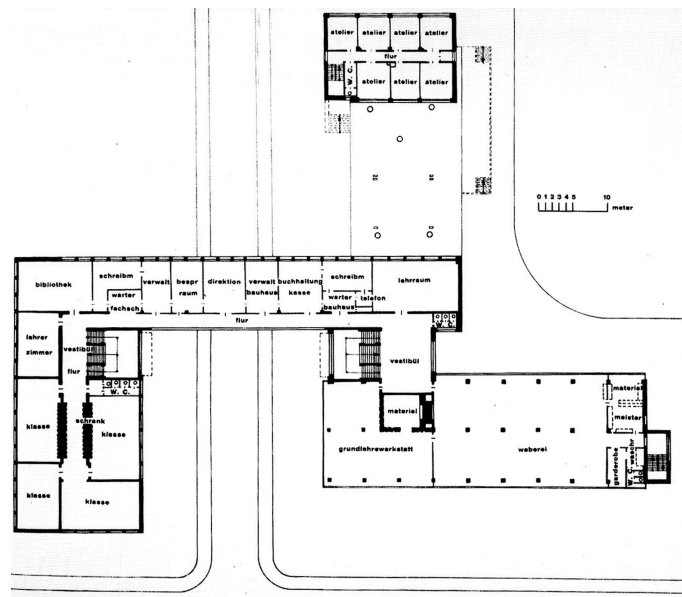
W. Gropius, *Bauhausgebäude Dessau*, Grundriss 1. OG, 1926
